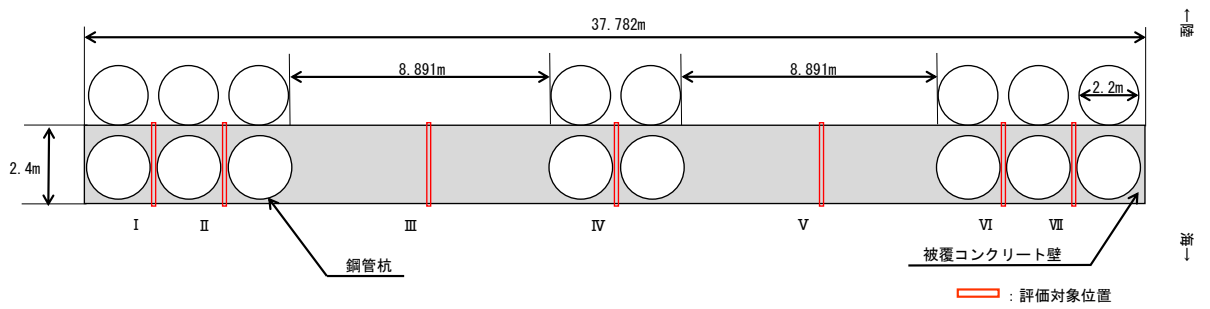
(1) 評価対象位置図 (④-④断面, 平面図)
